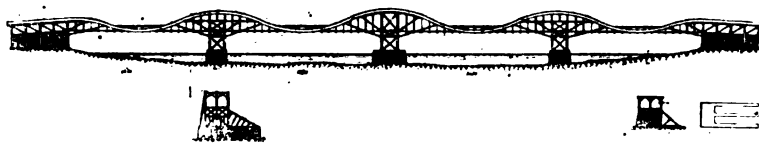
à 18. — Pont sur le Mowhawk à Schenectady.
